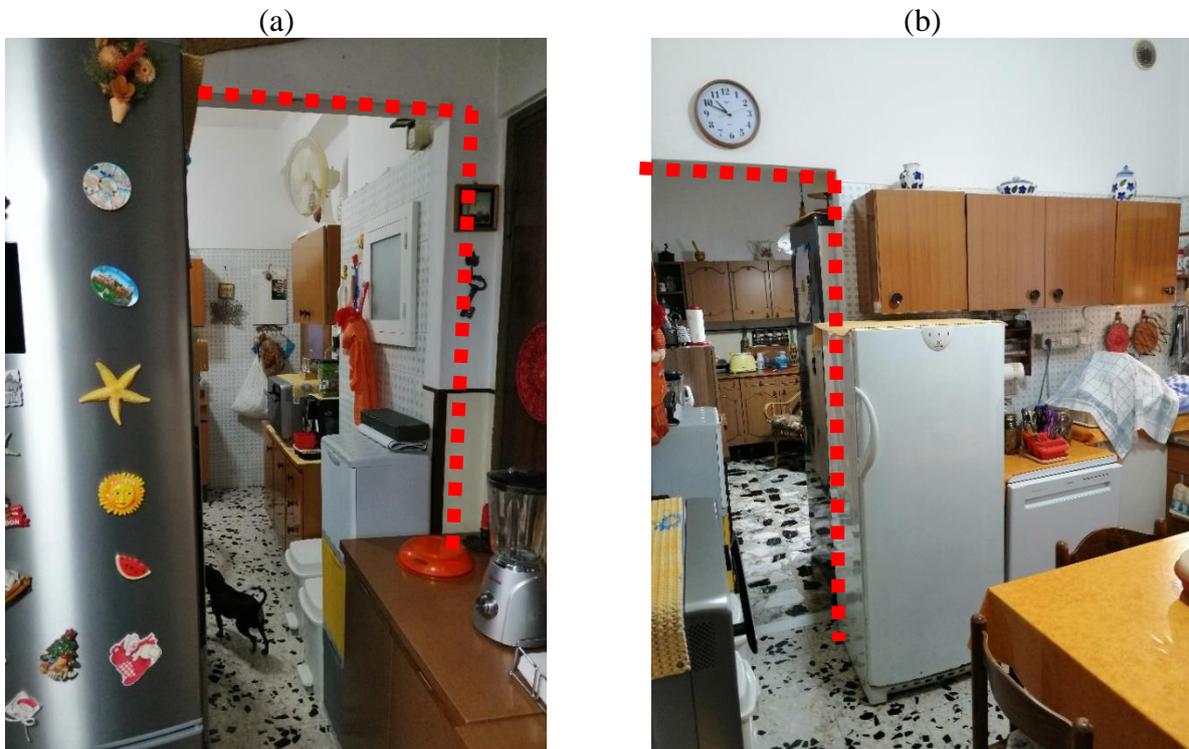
Apertura presente nella parete divisoria tra i due appartamenti vista da sub.9 verso sub.10 (a) e viceversa (b)
